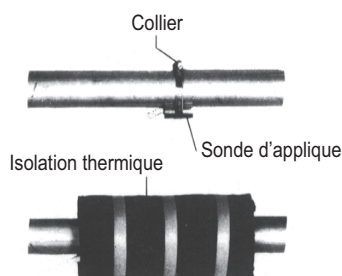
Montage d'une sonde d'applique sur tuyau
